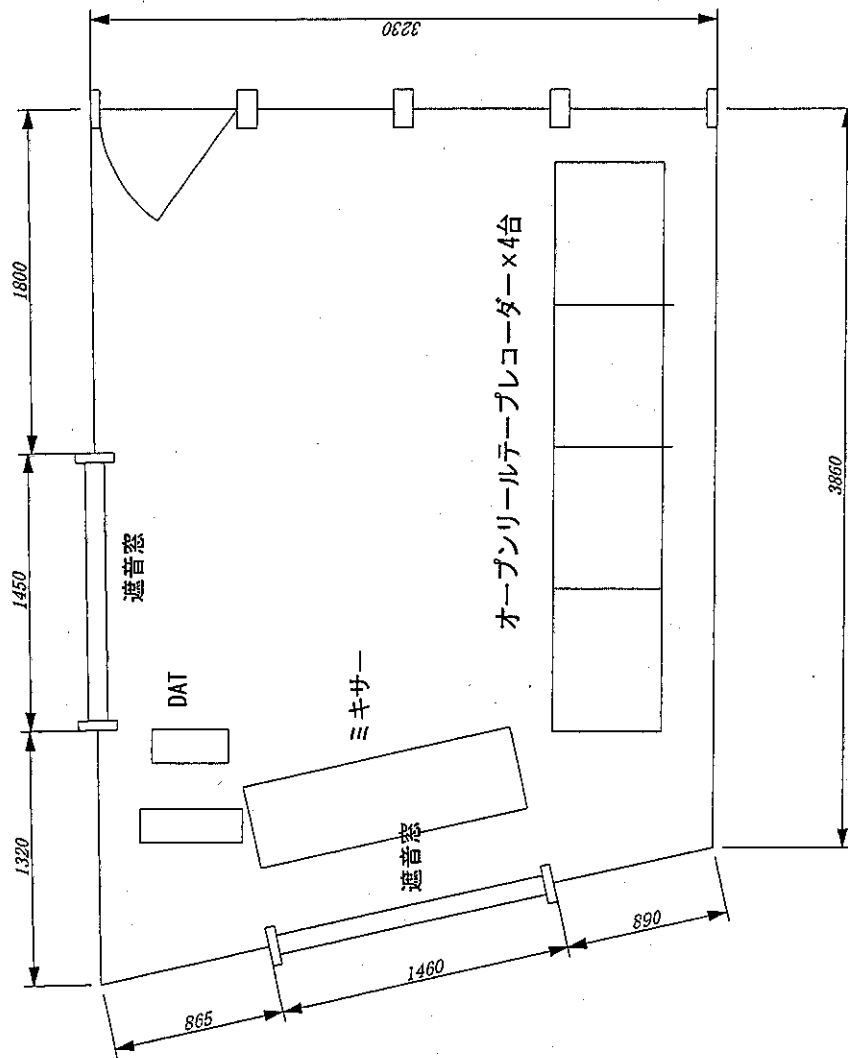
スタジオ機材設置予定平面図 (第6スタジオ)
